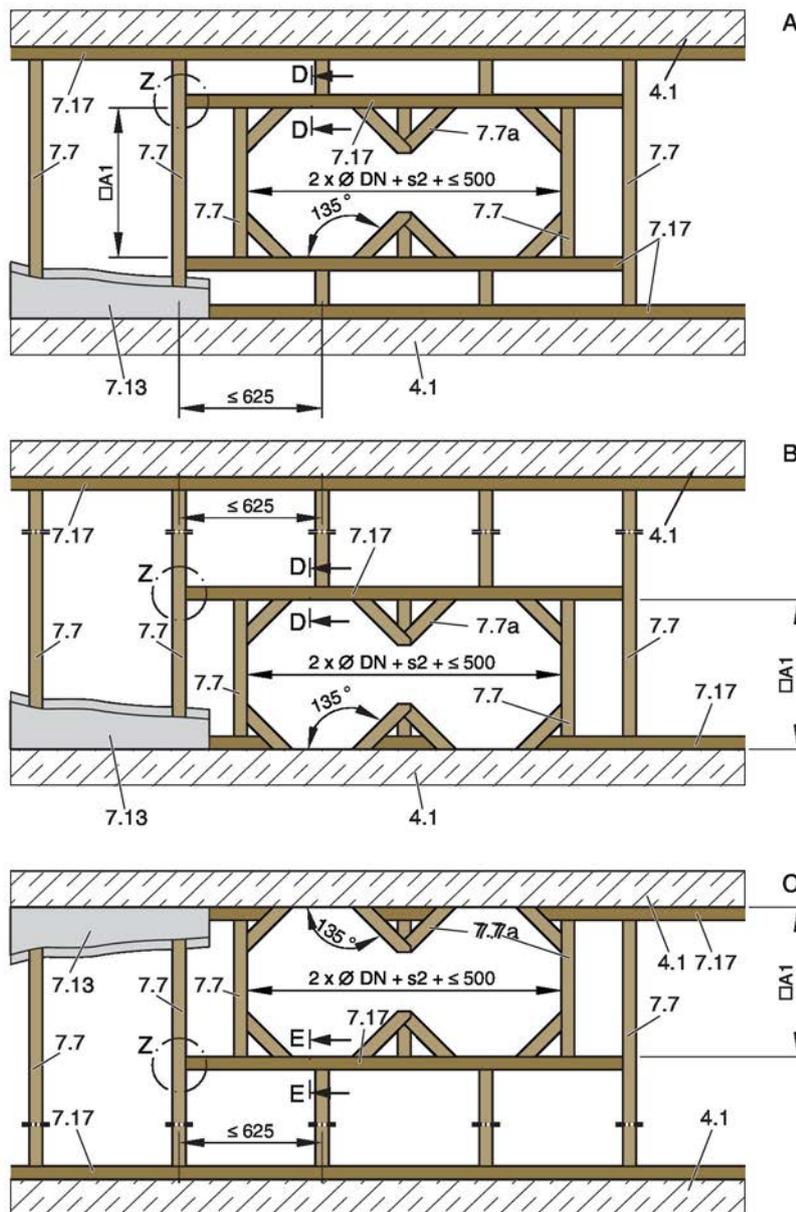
Parede divisória leve com estrutura de apoio de madeira e revestimento em ambos os lados, flange a flange, dimensões nominais: Ø largura nominal 450 – 800
